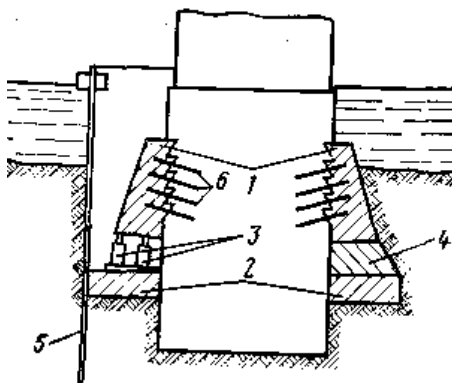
Усиление фундамента путем его уширения: 1 – железобетонные консоли; 2 – бетонная плита; 3 – домкраты; 4 – участок, бетонируемый после обжатия грунта под плитой; 5 – шпунтовое ограждение; 6 – стальные анкеры
